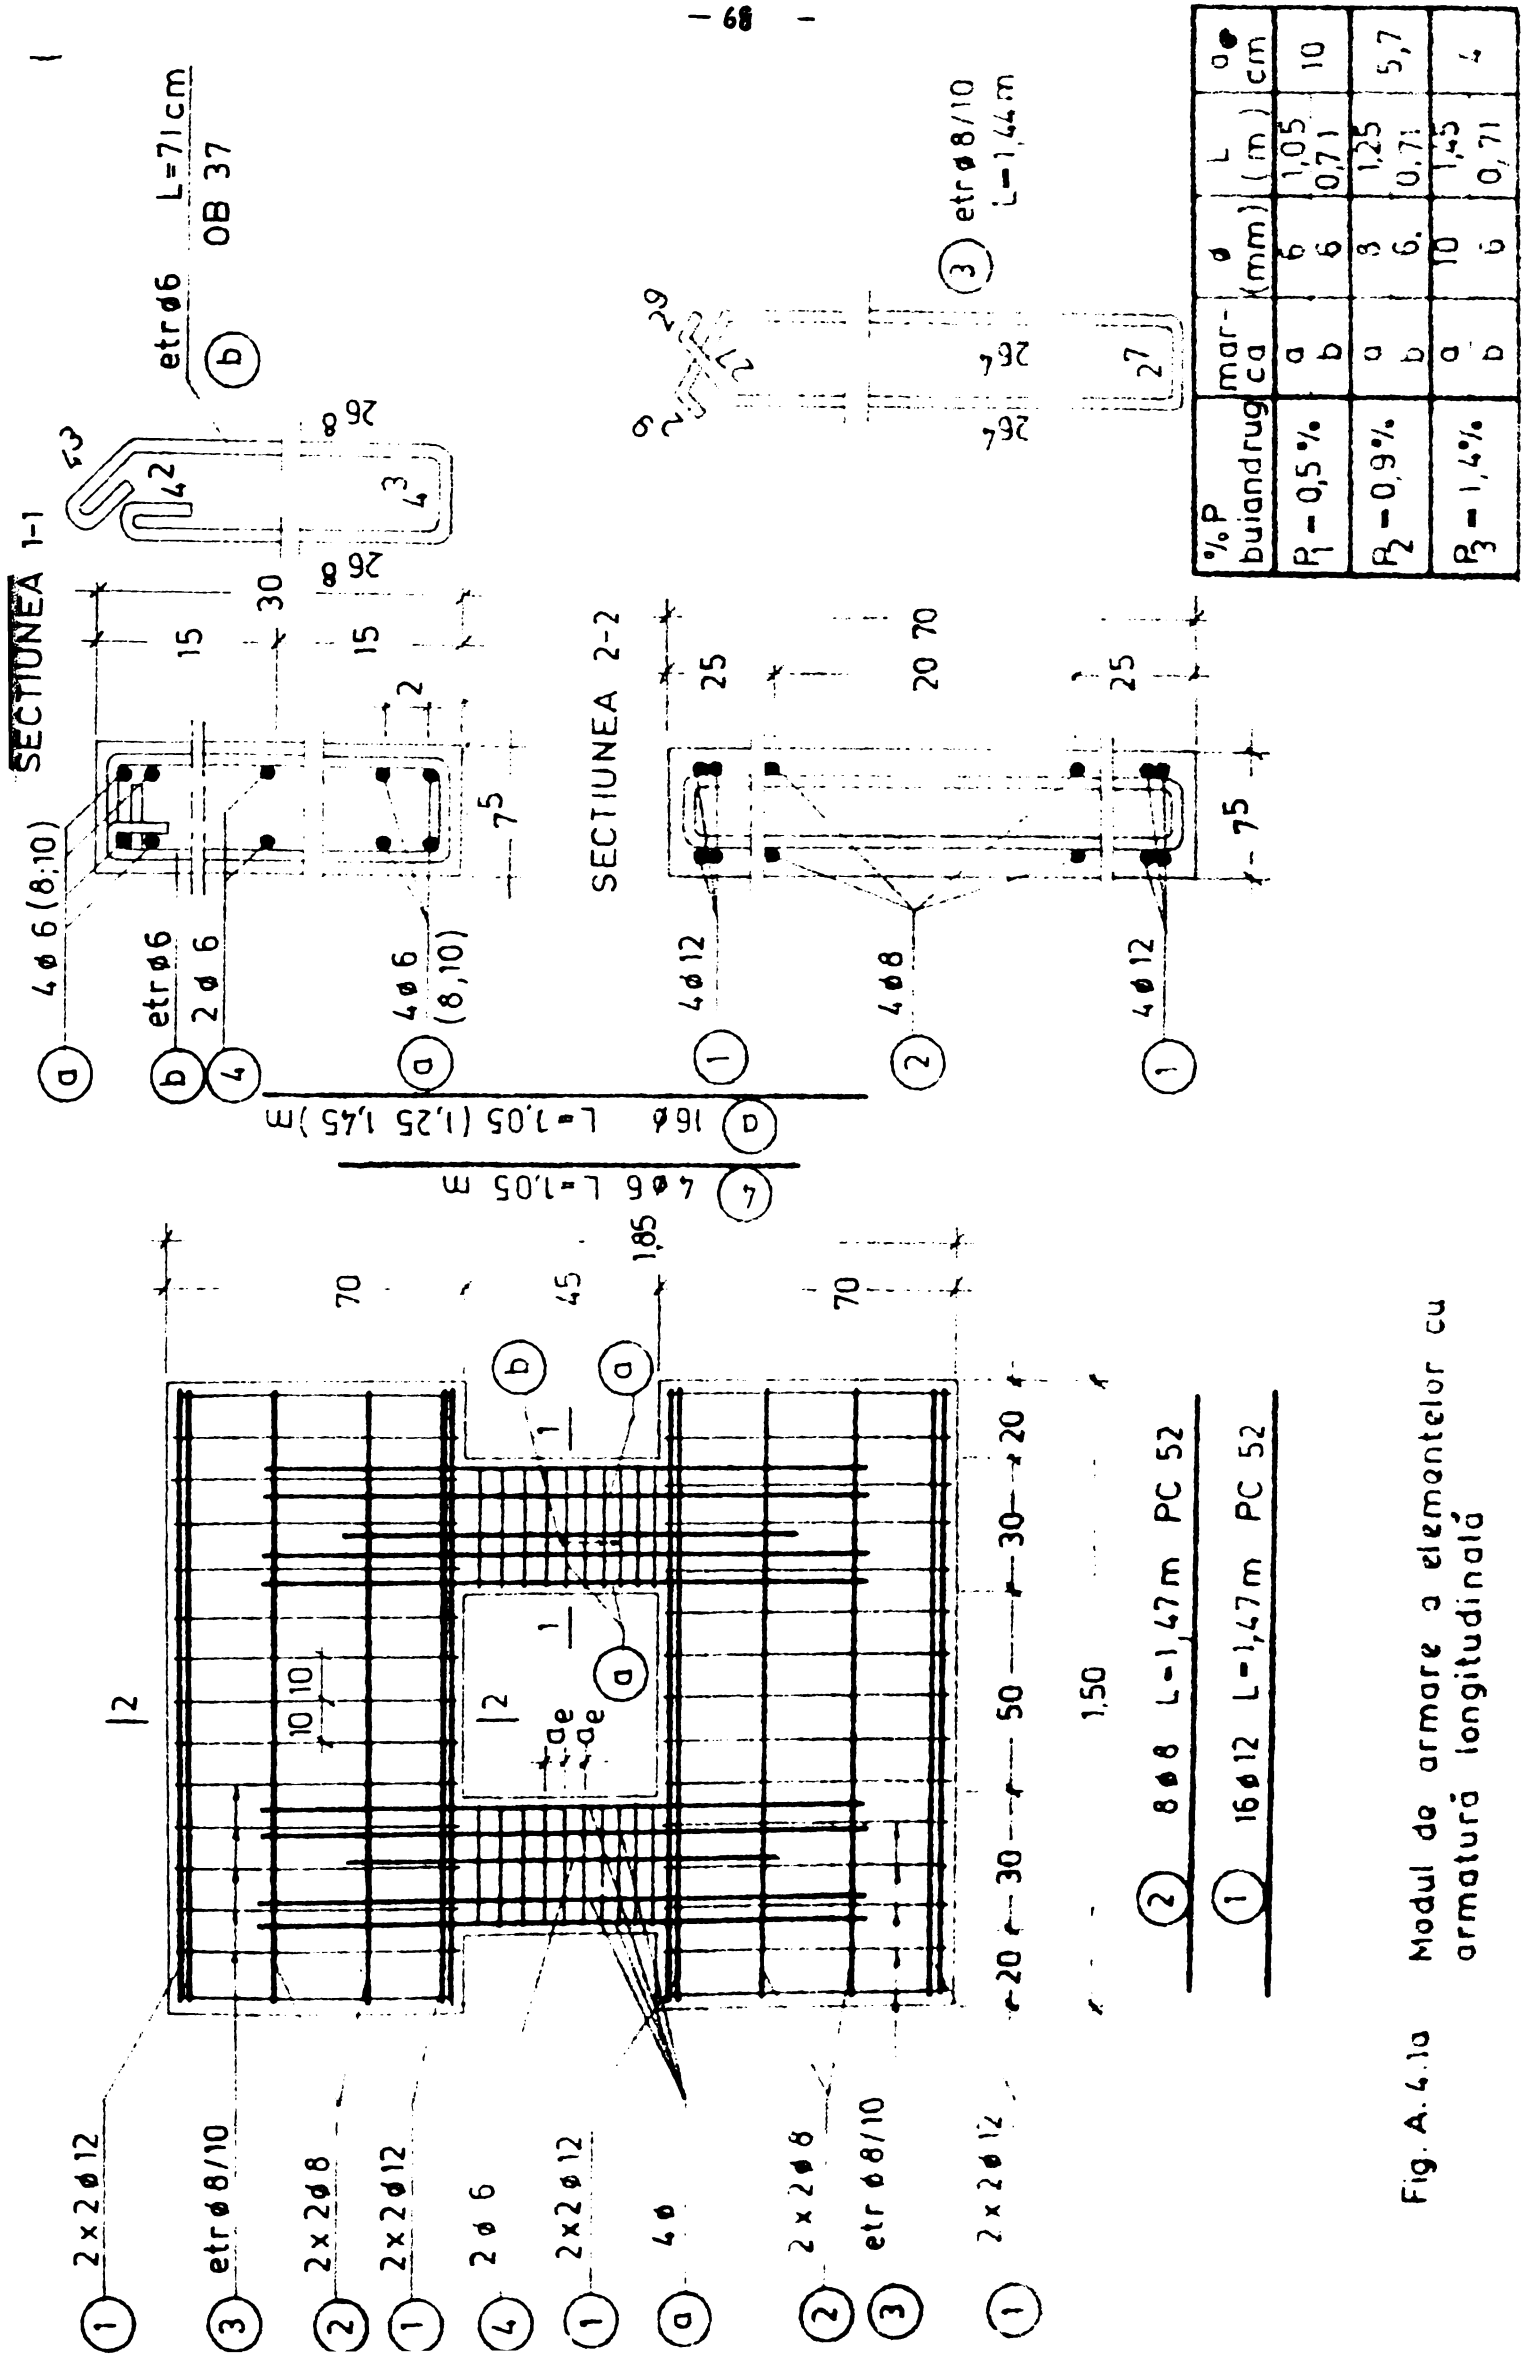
Modul de armare a elementelor cu armatură longitudinală
